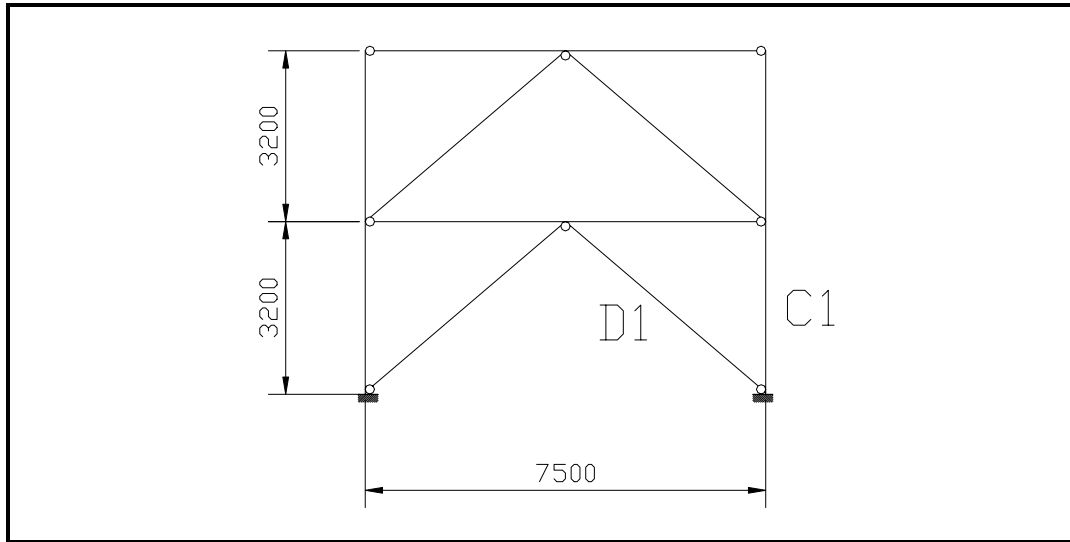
Pórtico contraventado de dois pavimentos.
